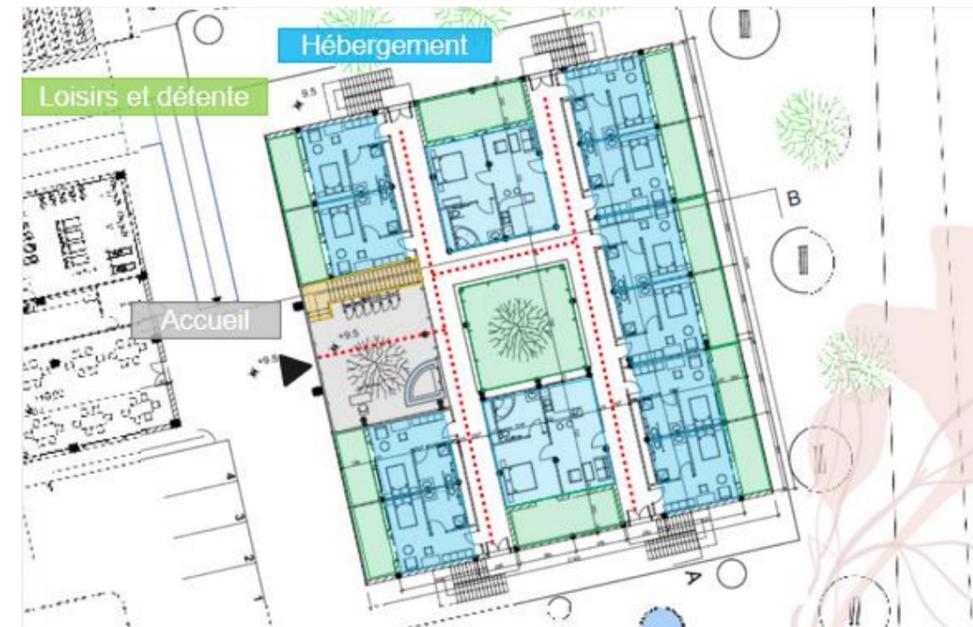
Plan du rez-de-chaussée – Résidence des seniors
